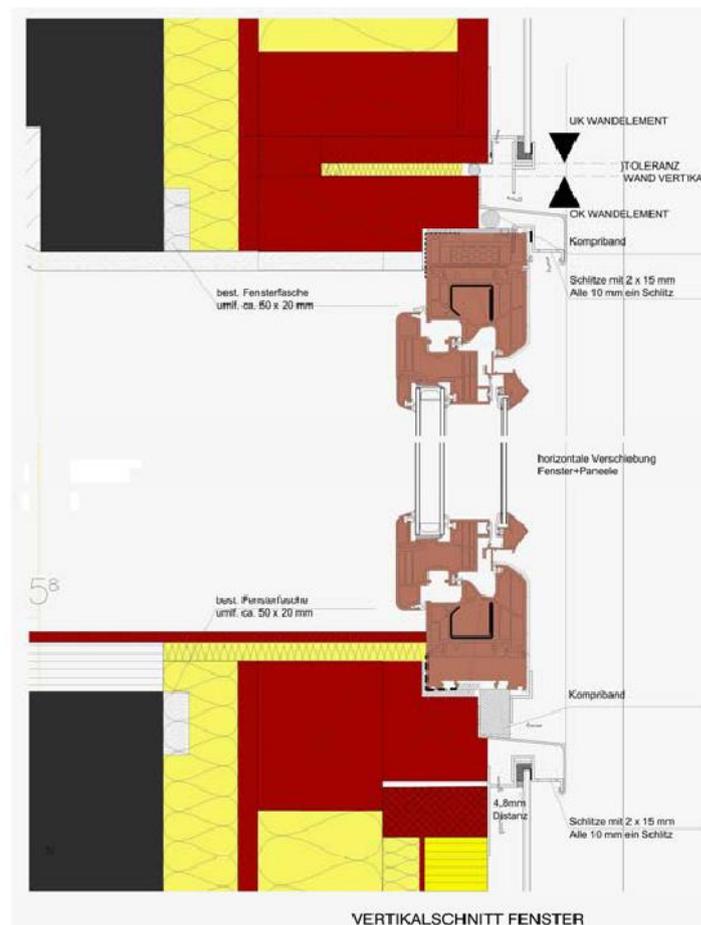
Detail vom Fenster [Quelle: BauXund, 17&4]
